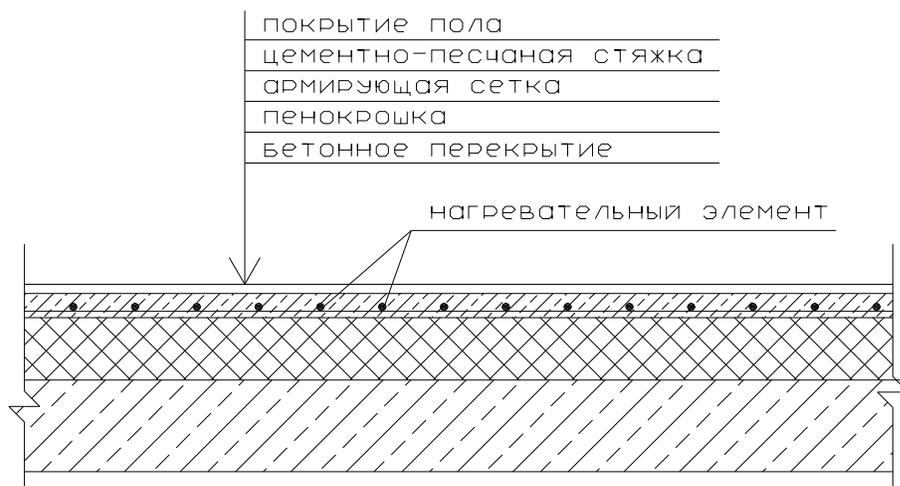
Тепловая изоляция пола из пенокрошки на перекрытии
